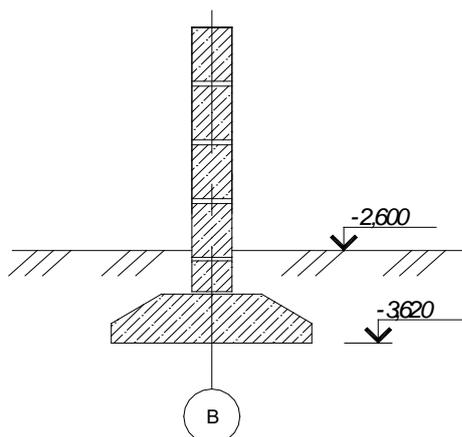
Схема к определению глубины заложения фундамента внутренней стены
